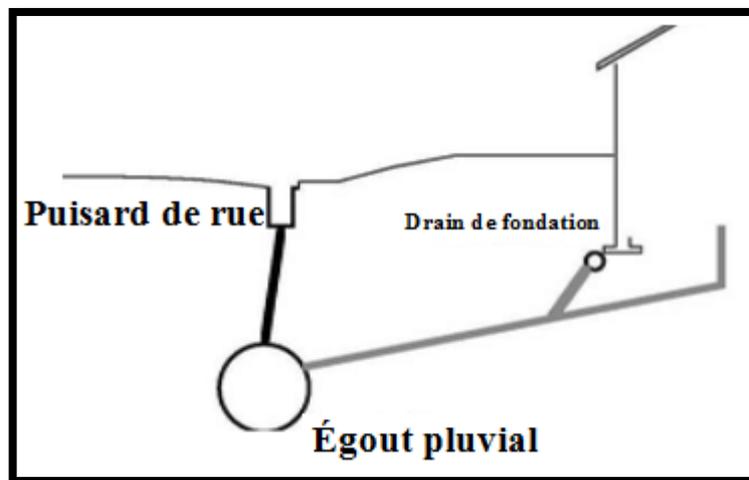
Schéma de système unitaire (Gomella et Guerree, 1986)
